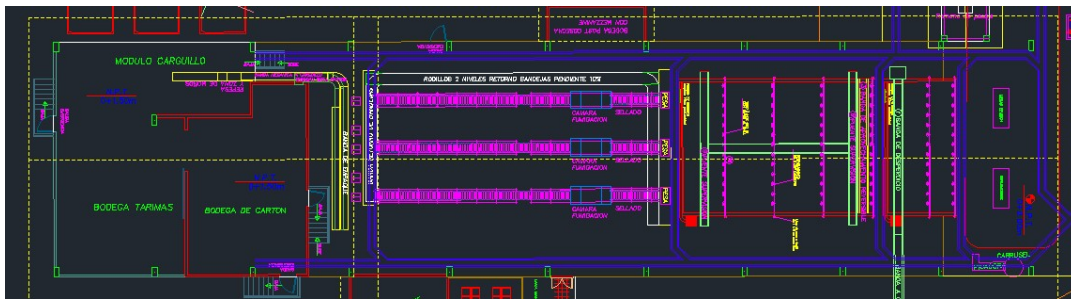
Plano arquitectónico del galpón 1 visto en planta.
